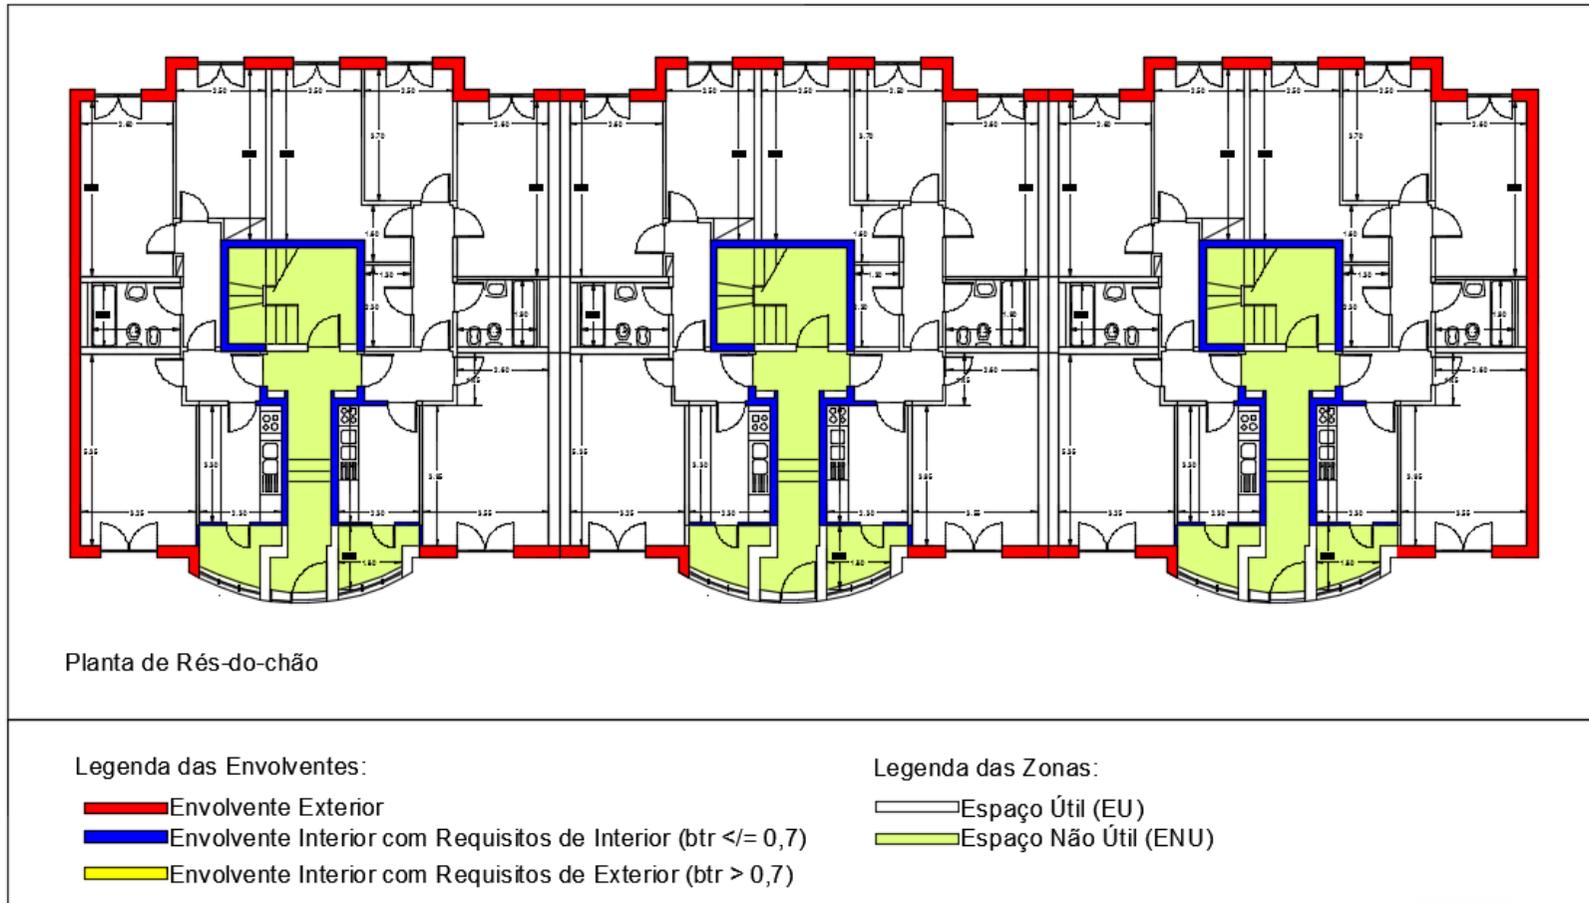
Definição da envolvente – Planta do rés-do-chão
